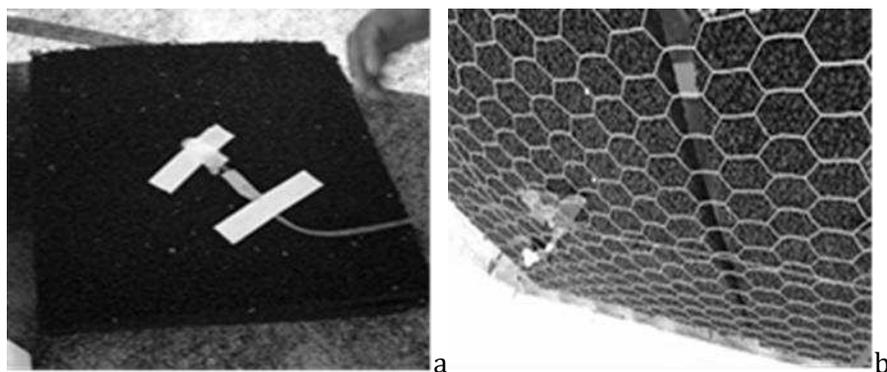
A) Sensores posicionados no centro da placa de forro, B) Sensor posicionado na superfície inferior e superior do forro.
